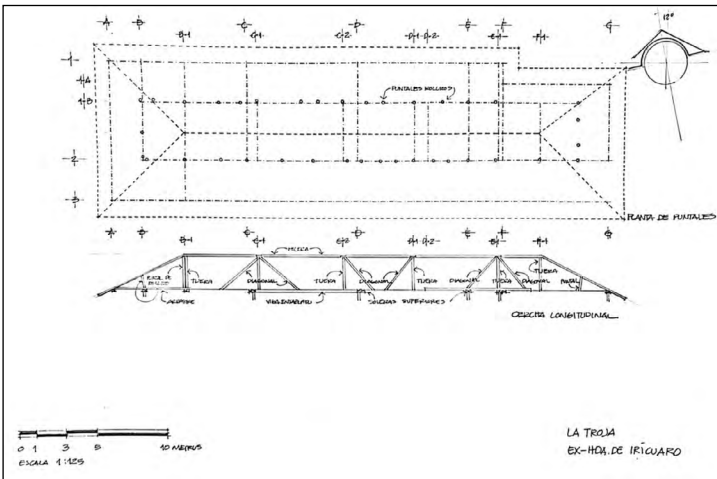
Planta puntales y corte longitudinal de cercha principal.
